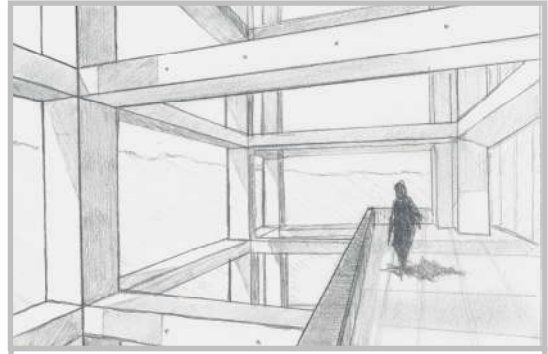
Croquis perforaciones en fachada norte utilizadas como terrazas para oficinas.
